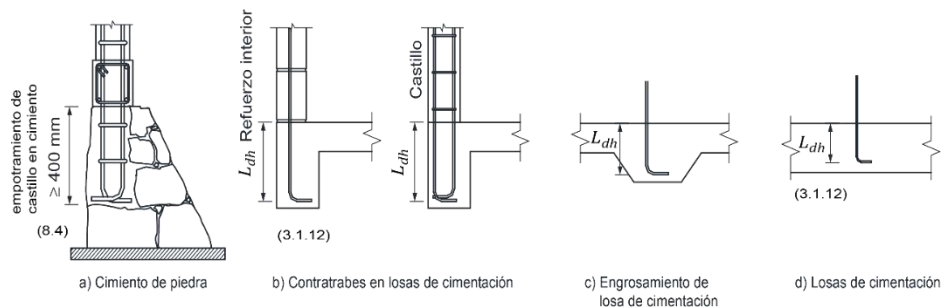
Anclaje del refuerzo vertical en cimientos
